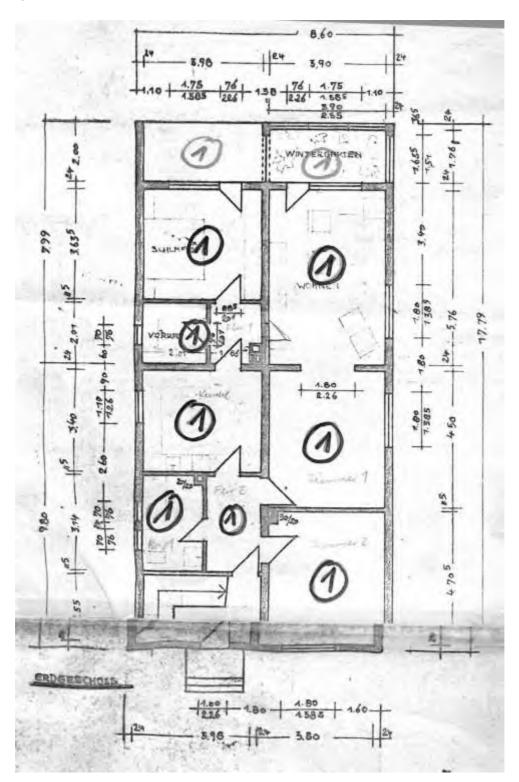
Grundriss Erdgeschoss (Nr.1 = Bewertungsgegenstand)
